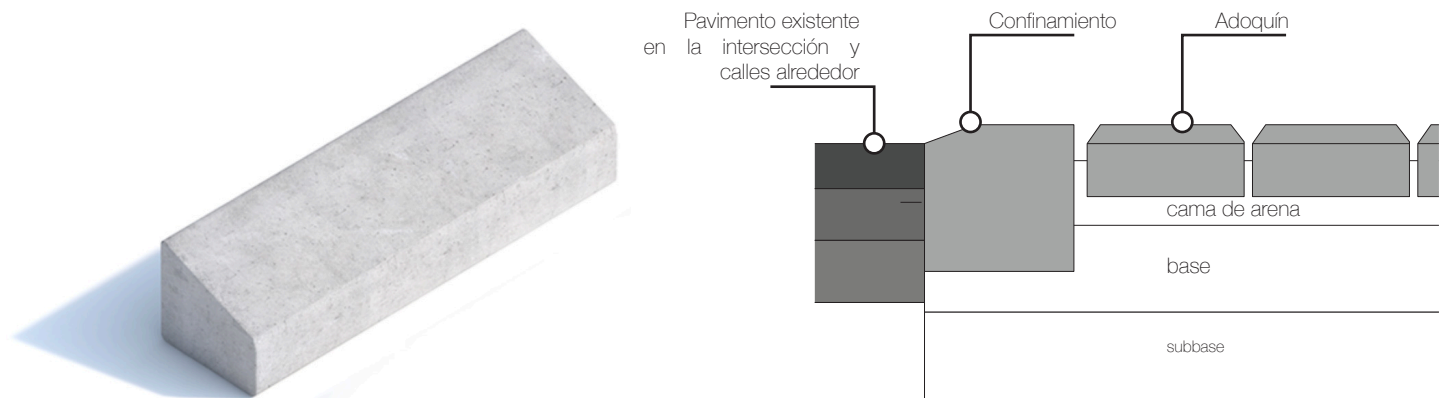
Colocación de elementos de confinamiento para el pavimento de adoquines.
